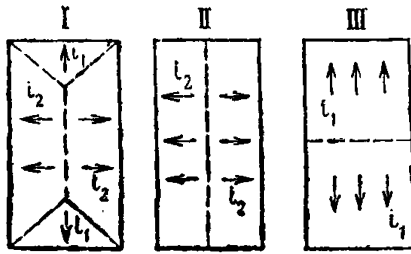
(к прил. 1). Схемы уклонов на открытых спортивных площадках
